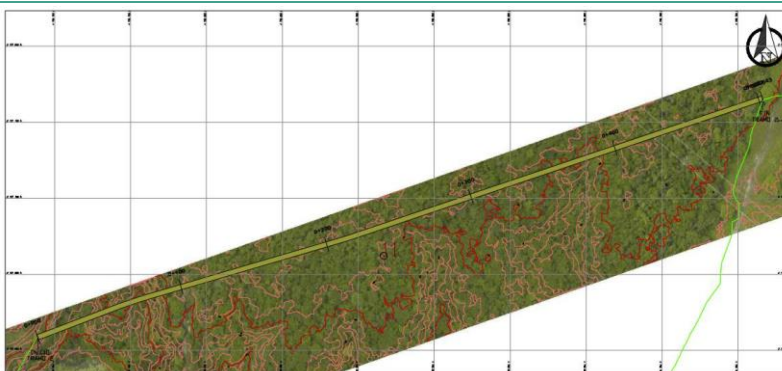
Vista Planta Acceso Nuevo Tramo 1
